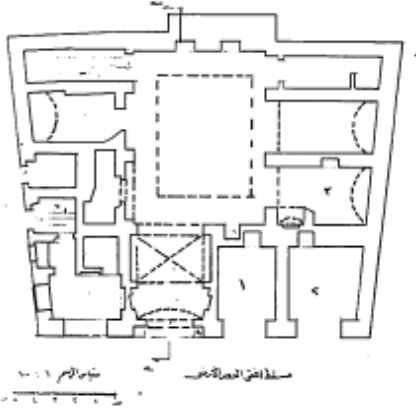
خان داود باشا برشيد: مسقط أفقي للطابق الأول نقلاً عن محمد الحلوجي، دراسات في وكالات رشيد المندثرة من واقع الوثائق
